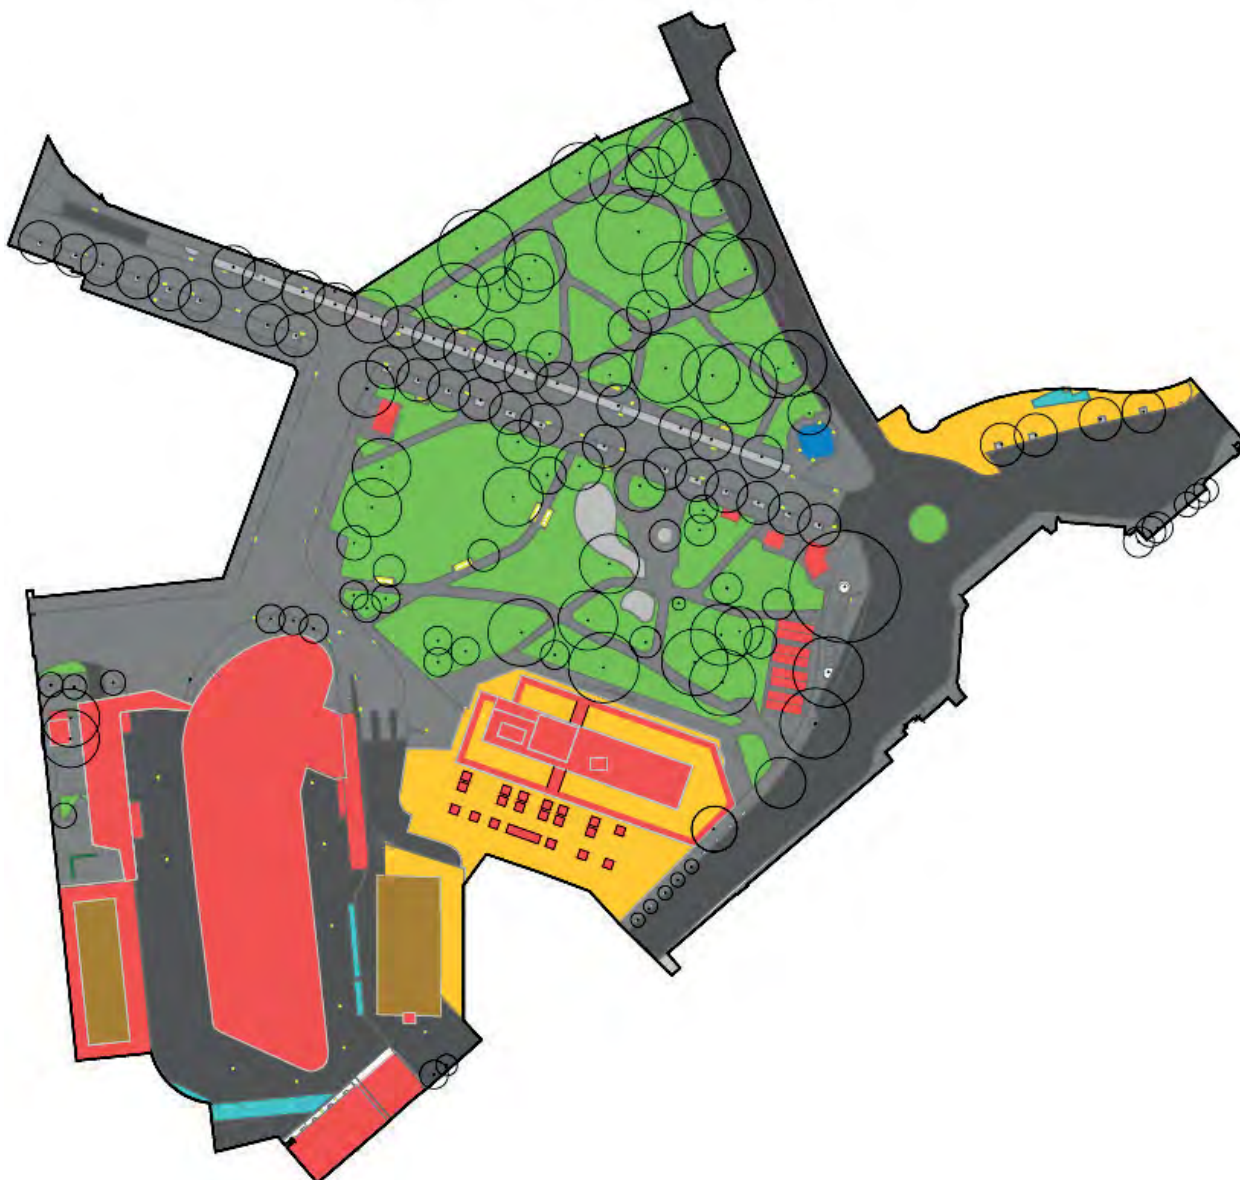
RIE - Riduzione dell'Impatto Edilizio – RIE 1 – planimetria superfici – in verde le superfici permeabili
